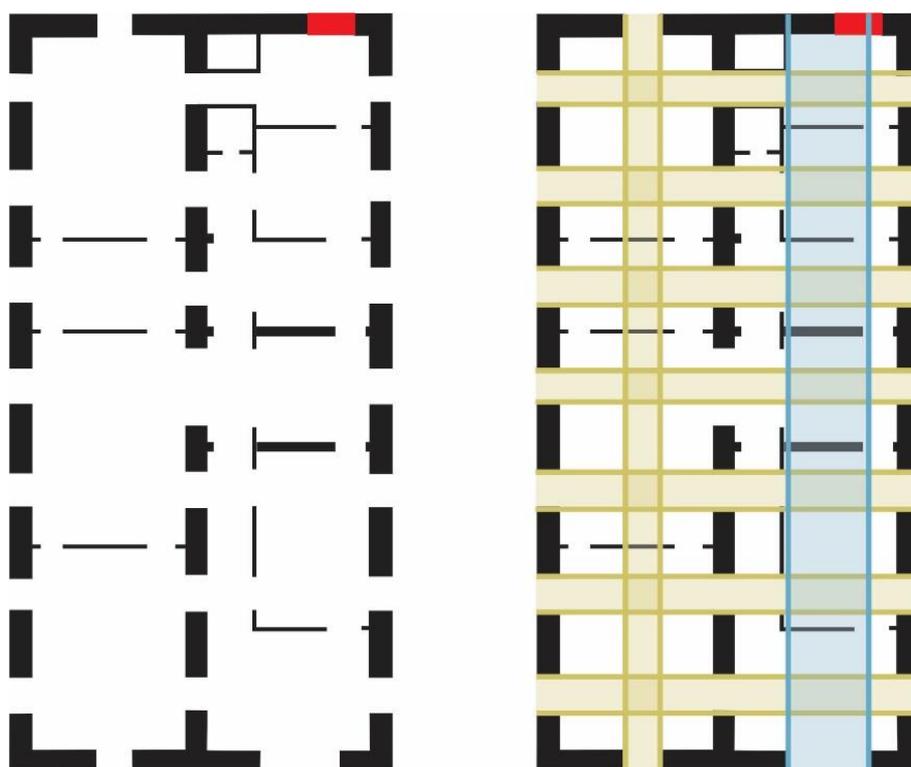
Planta baixa do 2º pavimento do Bloco II do PSC em 1864. Em amarelo são as simetrias entre as sacadas e, em azul, das portas.
